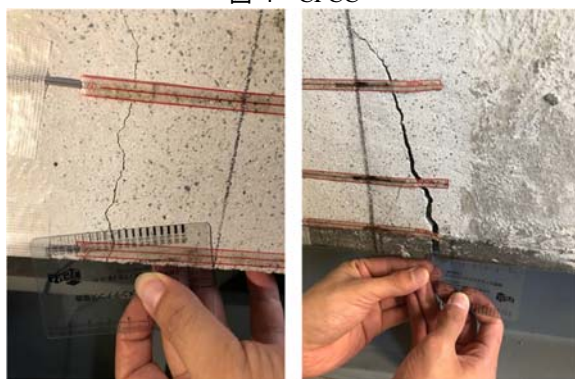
ひび割れ状況 (左：無補強 右：補強)
